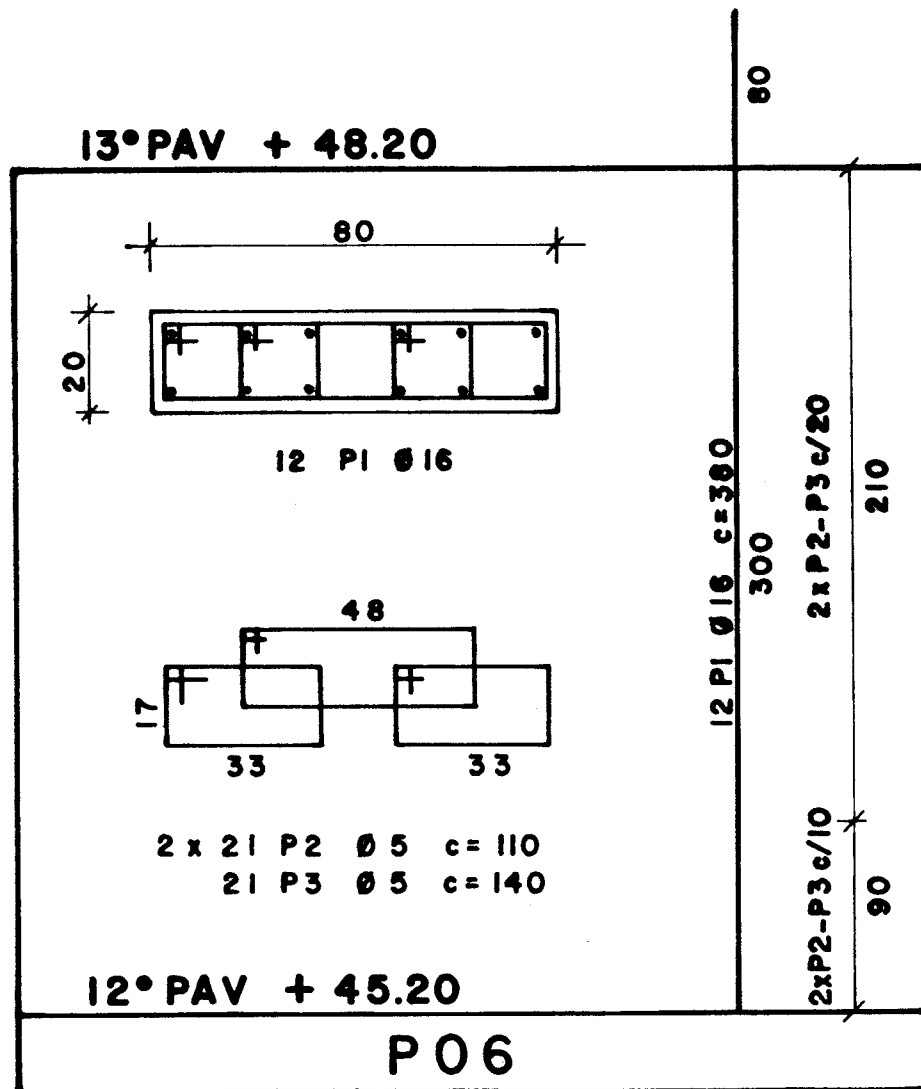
Detalhamento final de um pilar em concreto armado.
